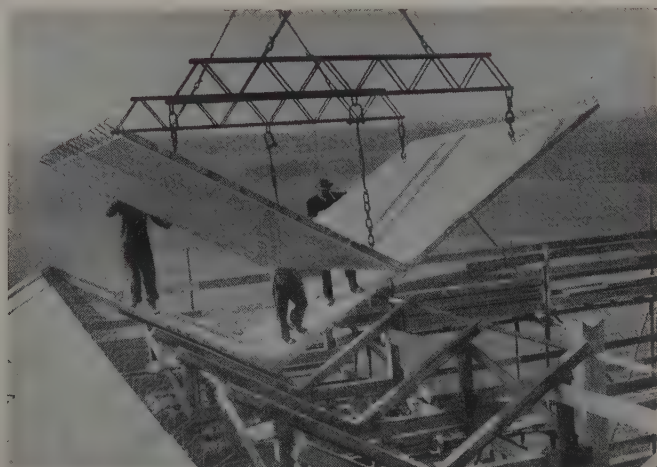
Einbau der Elemente mit Spezialtraversen (6-Punkt-Aufhängung)
